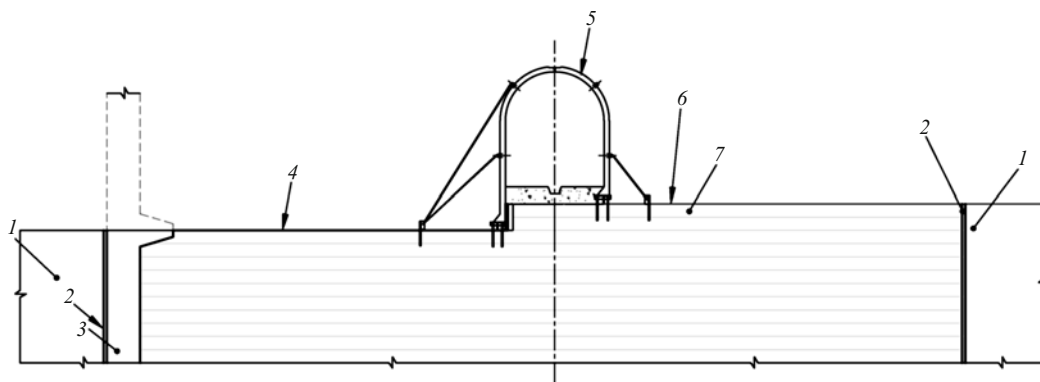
Технология выполнения швов-надрезов и инспекционных галерей в бетонном ядре плотины: 1 — переходная зона; 2 — сборная железобетонная опалубка; 3 — асфальтобетонный экран; 4 — шов-надрез; 5 — сборная железобетонная опалубка инспекционной галереи; 6 — строительный шов; 7 — укатанный бетон
